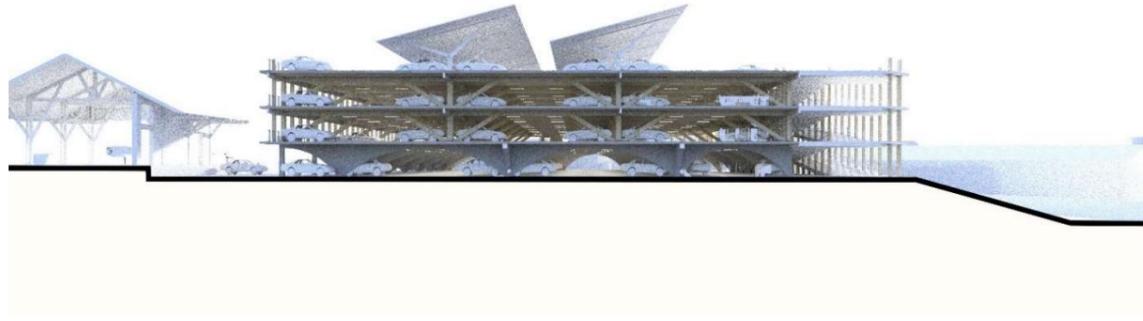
Croquis du projet de parking silo (source : SNCF Gare & connexions, avril 2022)
